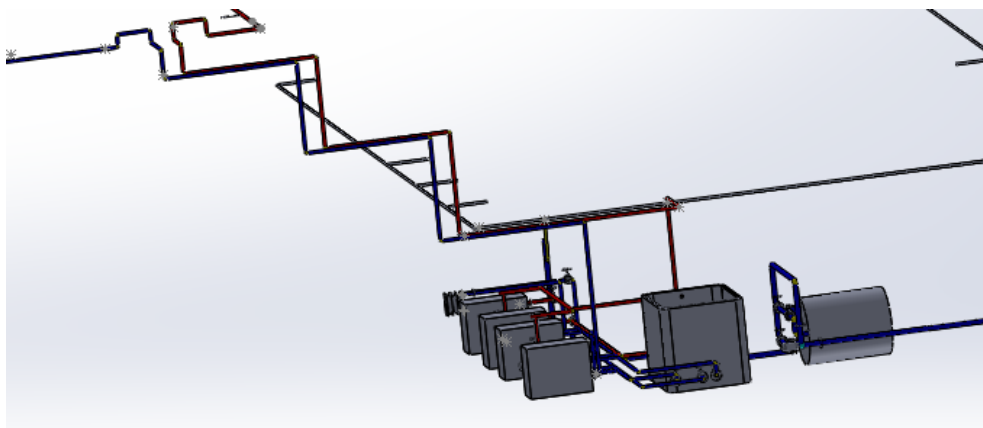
CAD de la planta media elaborado en Solidworks. Autor
